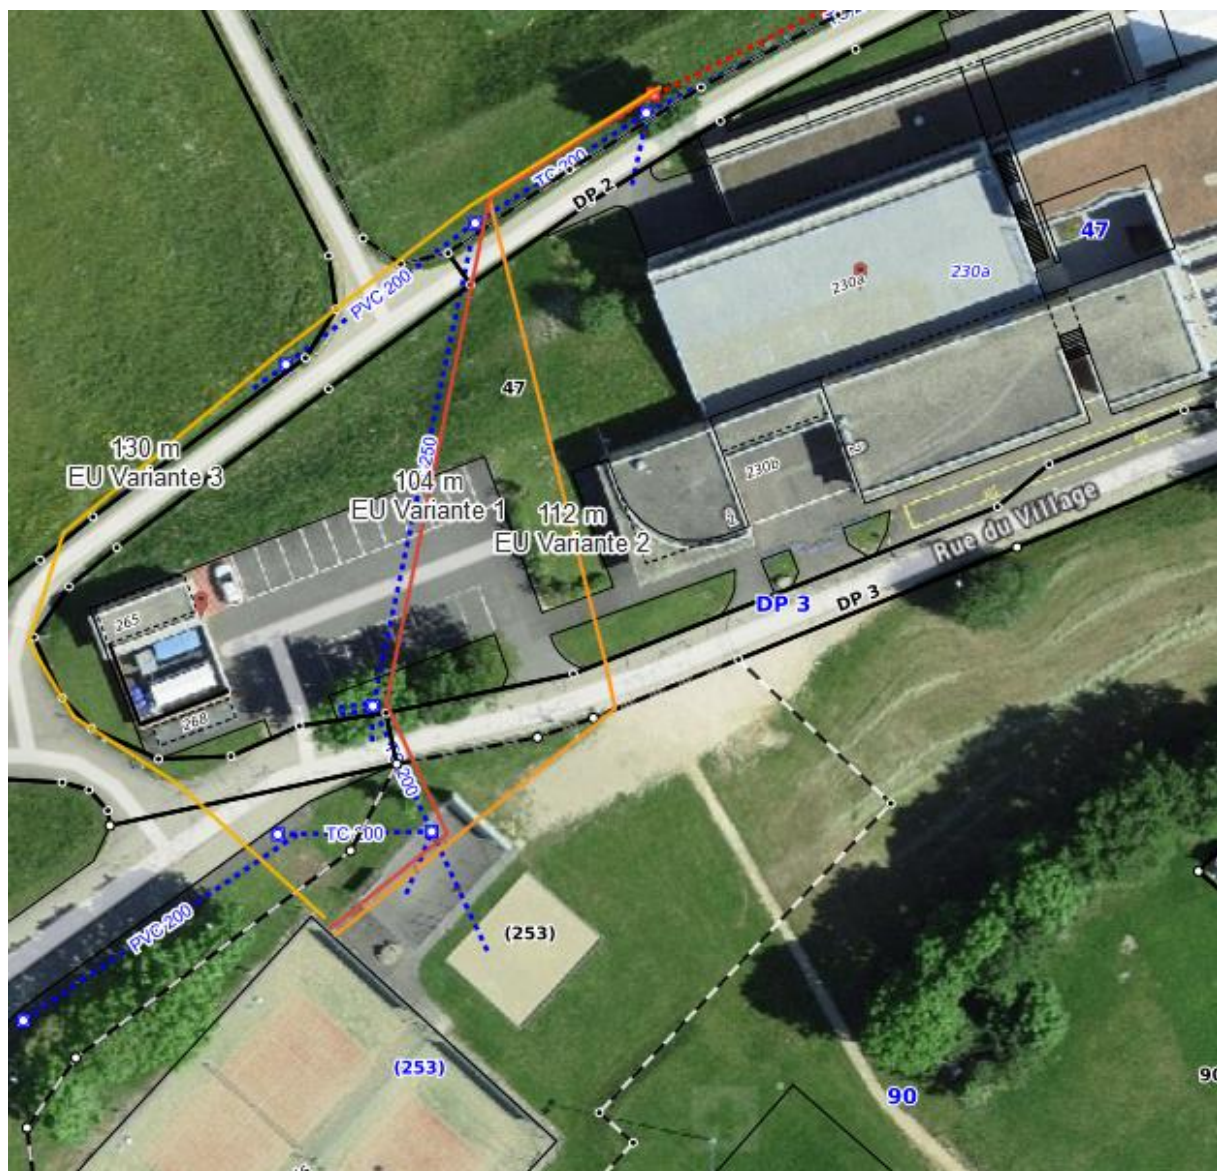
Propositions de parcours de la conduite EU de la parcelle 90 au raccord sur la conduite EU existante entre le collège de Chamblon et le terrain de foot.
